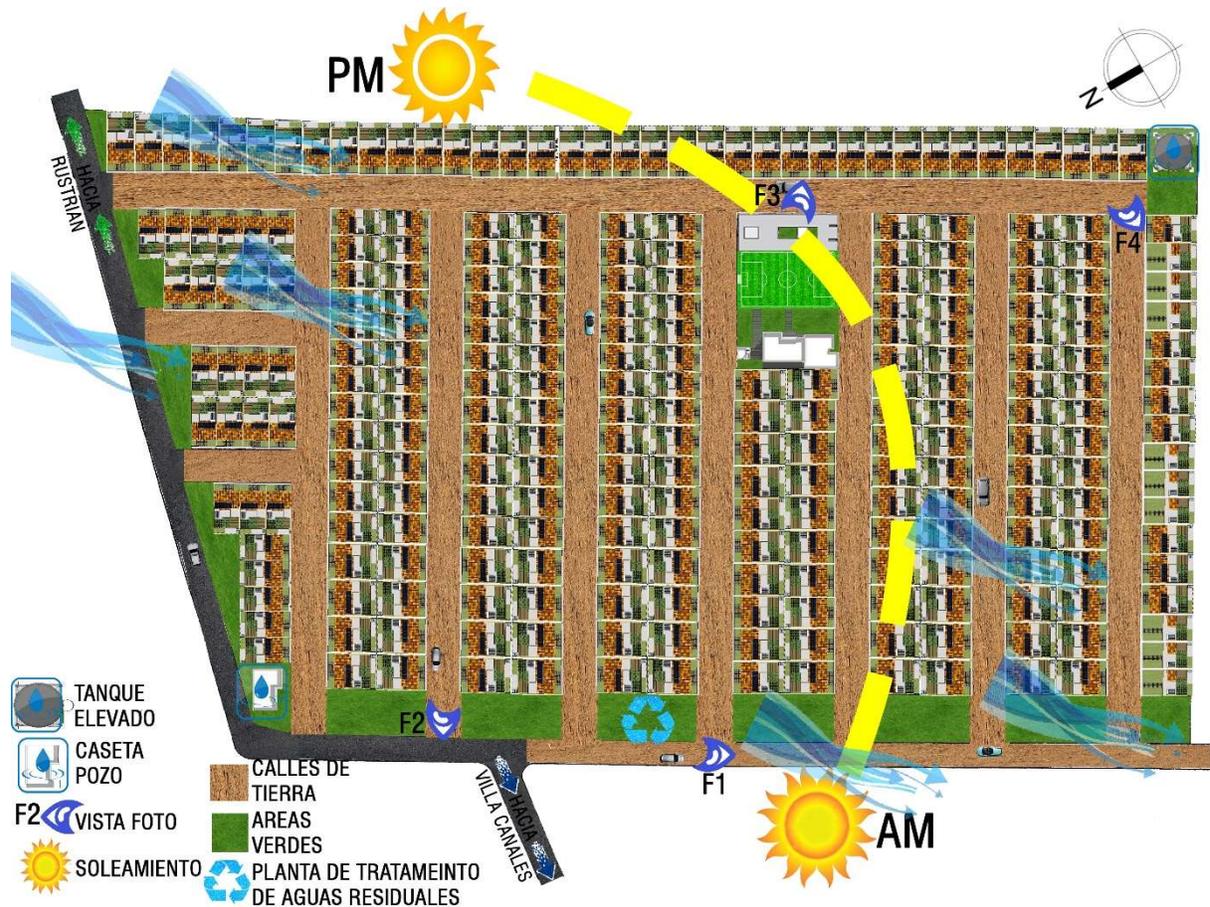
PLANTA DE CONJUNTO SOLEAMIENTO³⁵
